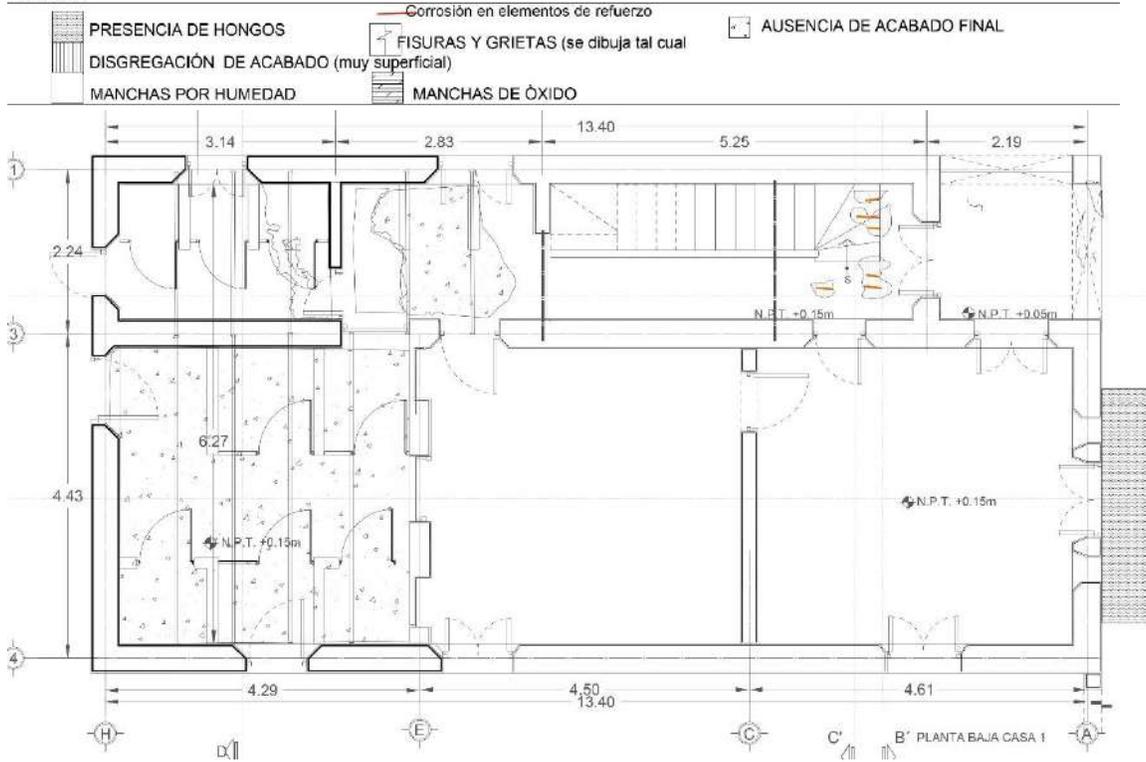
Planta de deterioros en plafones casa 1 (ver anexos planos para mayor comprensión)
